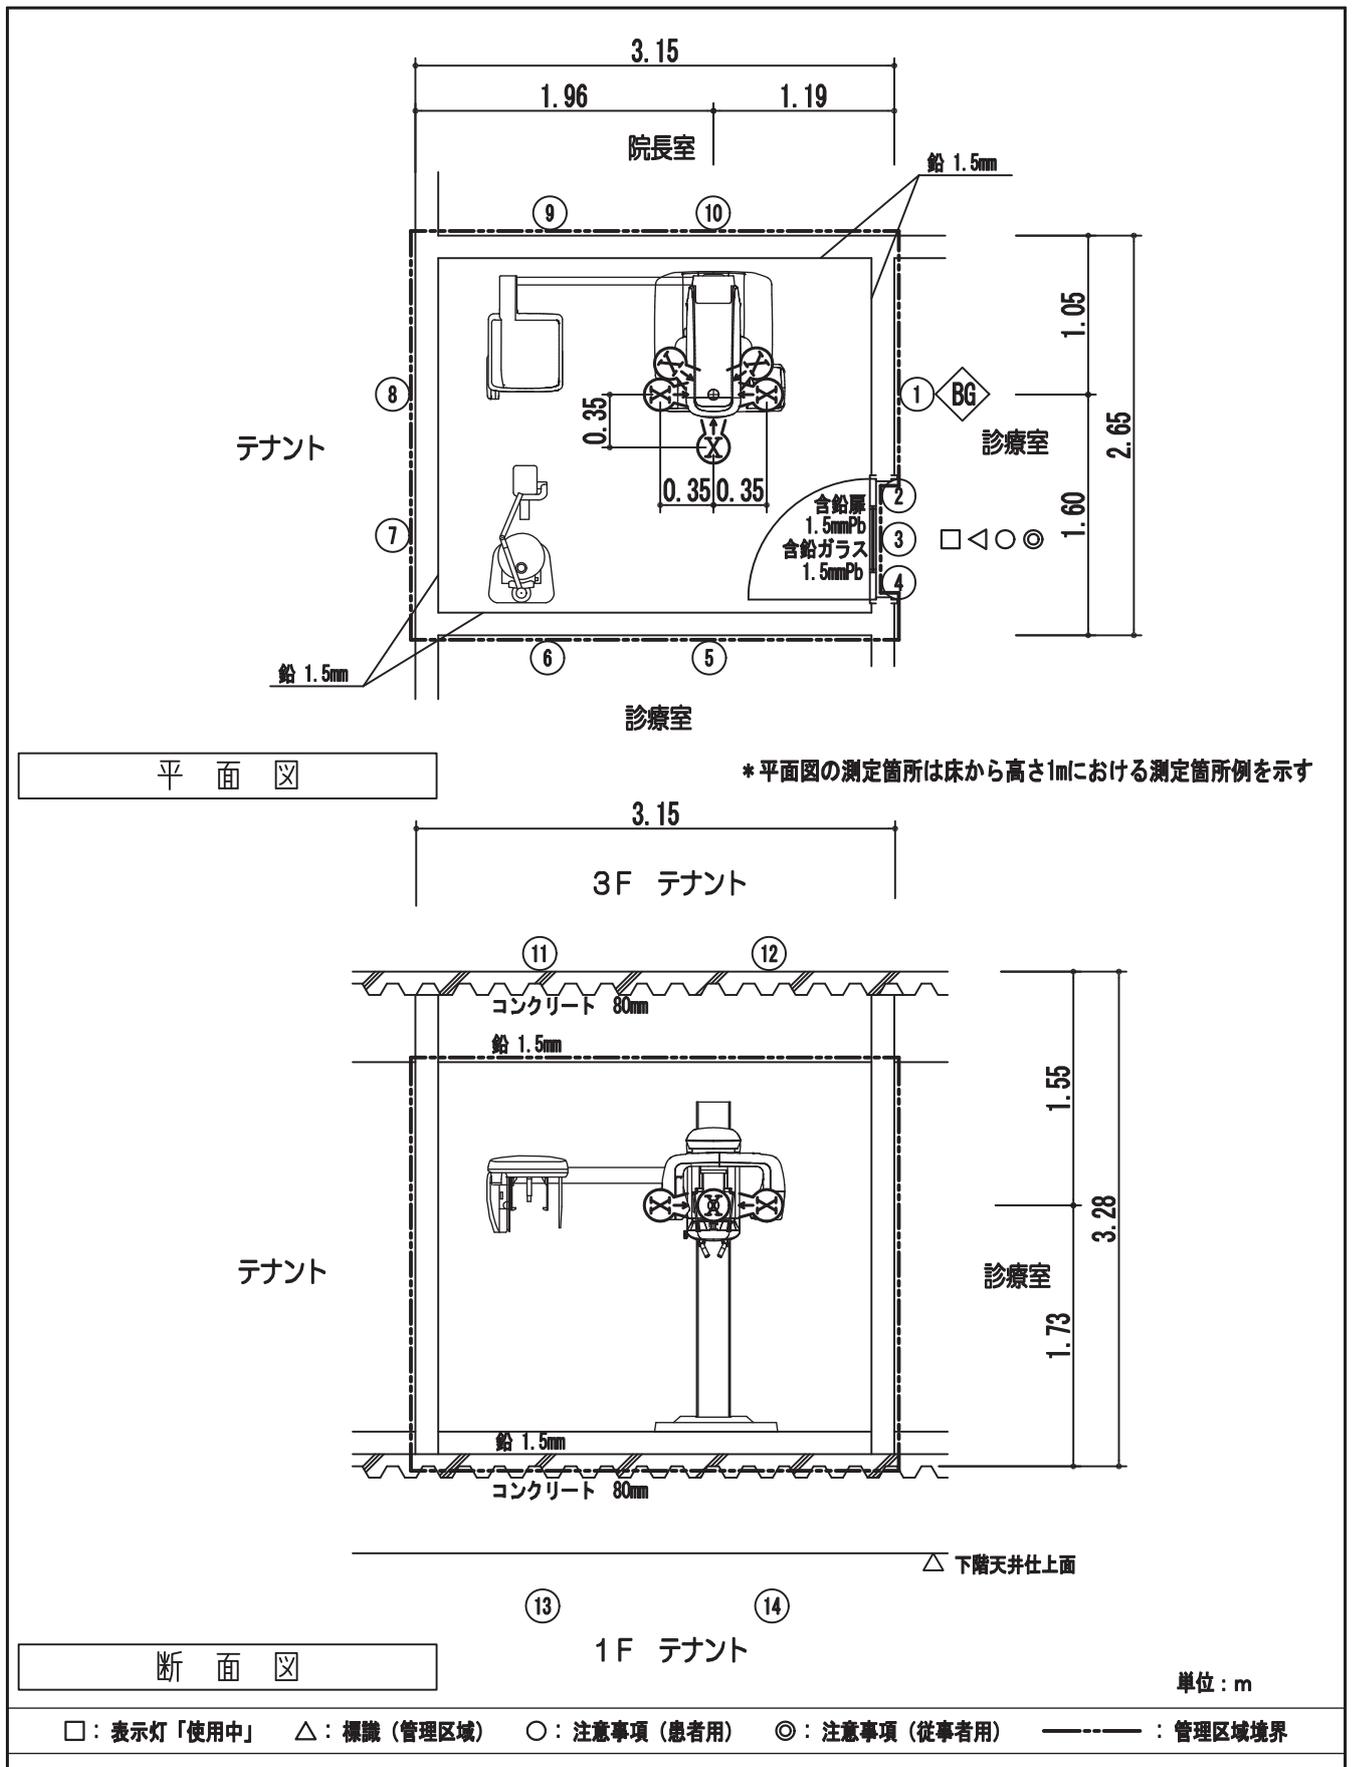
歯科用X線装置 パノラマ撮影 平面図・断面図
